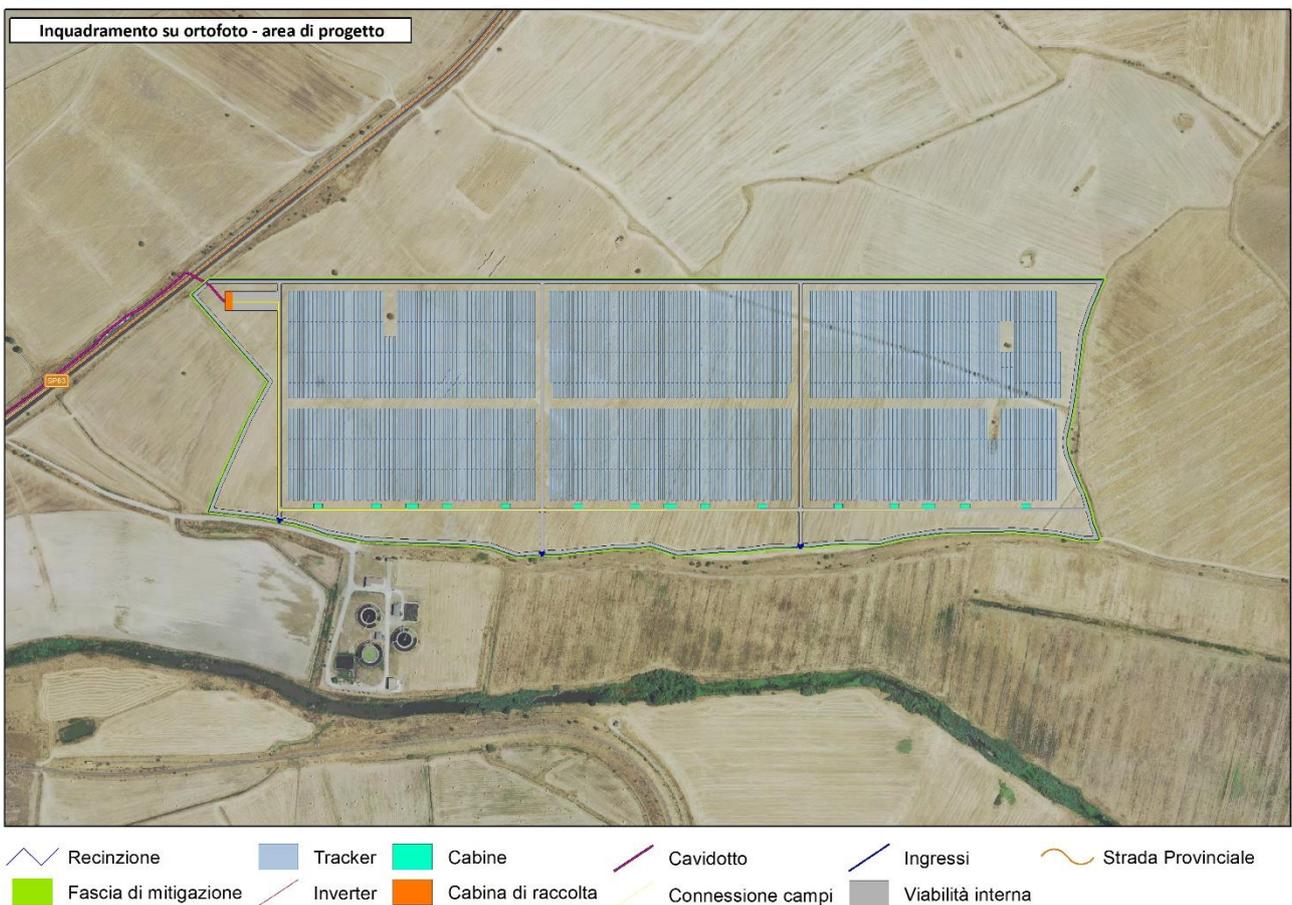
inquadramento su ortofoto - vista di dettaglio.
